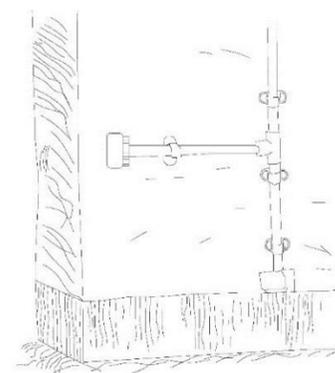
Instalaciones eléctricas pegadas a la pared.
